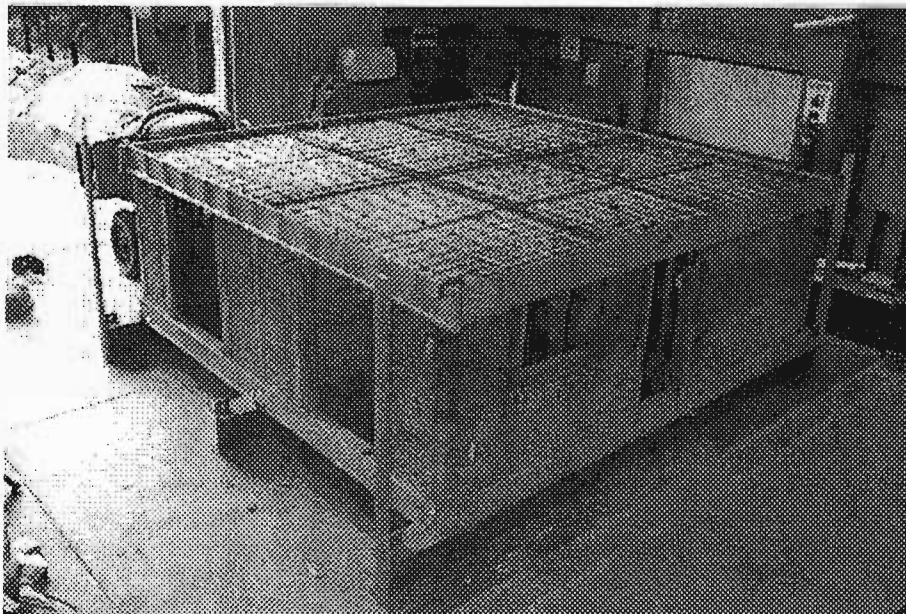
Acero de refuerzo en losa y dala de cerramiento
